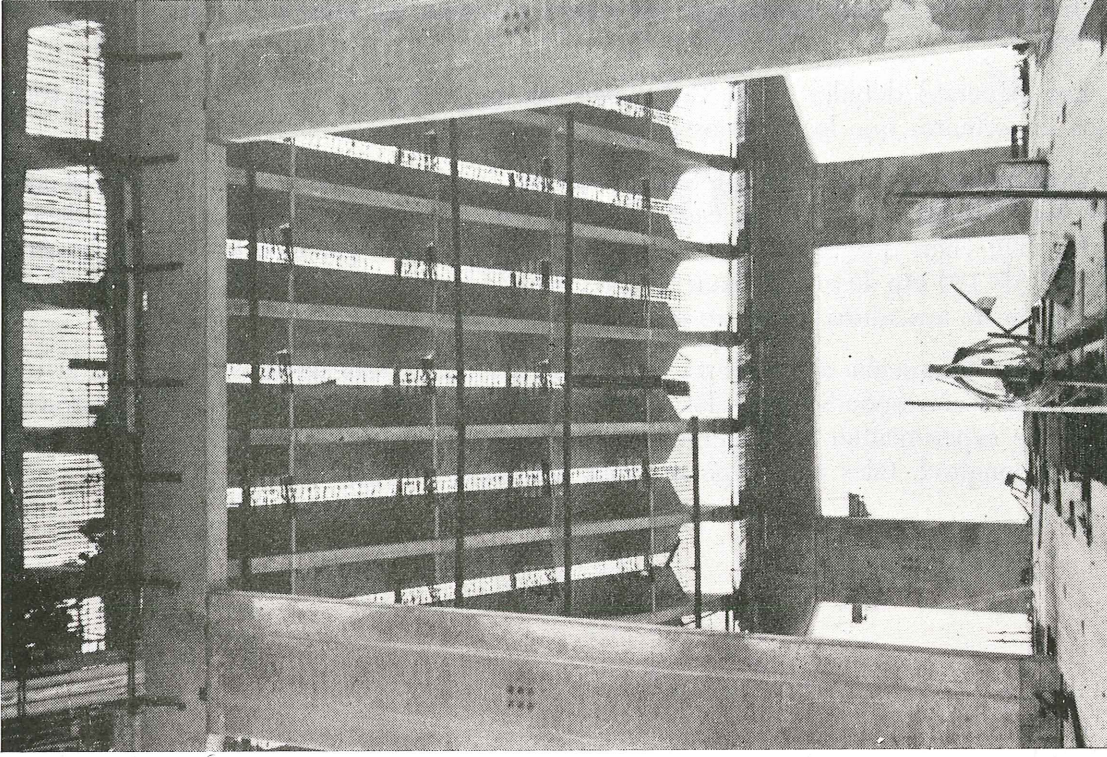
Vigas de un tramo del tablero, una vez colocadas.
